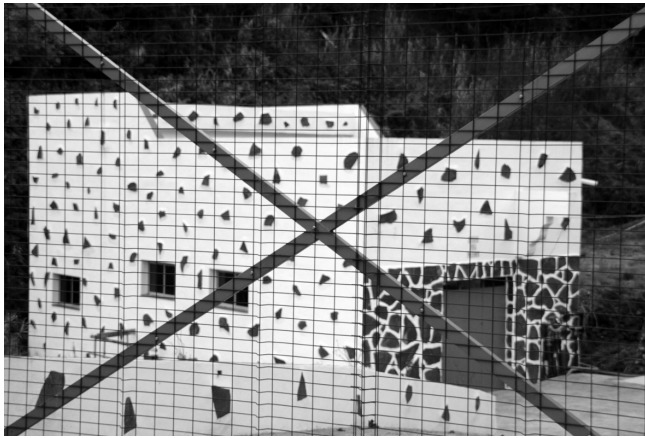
Apliques de piedra y pintado de piedras en fachadas de hormigón emula las juntas encaladas de la arquitectura tradicional.
